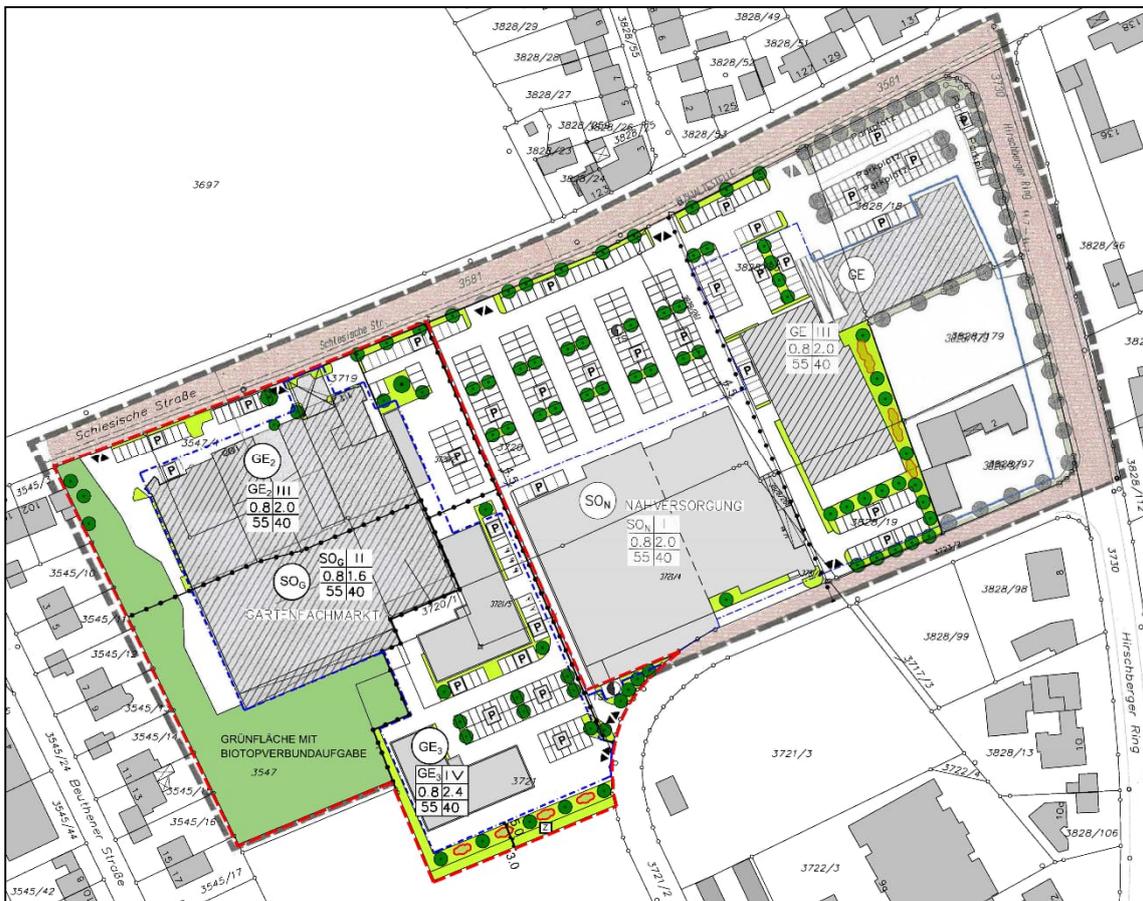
Bebauungsplan "Breslauer Straße" der Stadt Straubing /10/
